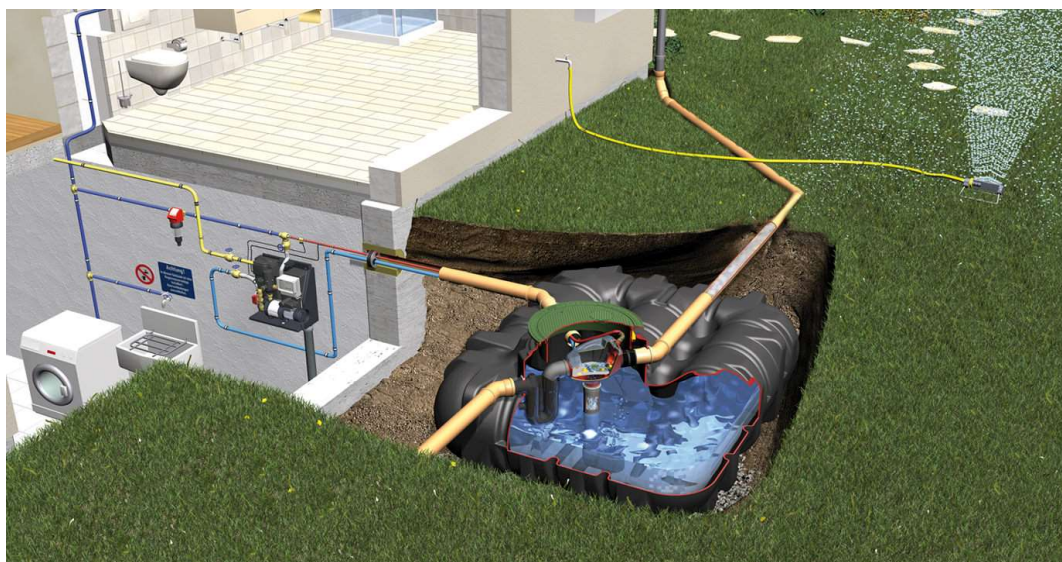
Schema funzionamento Impianto recupero acque piovane
